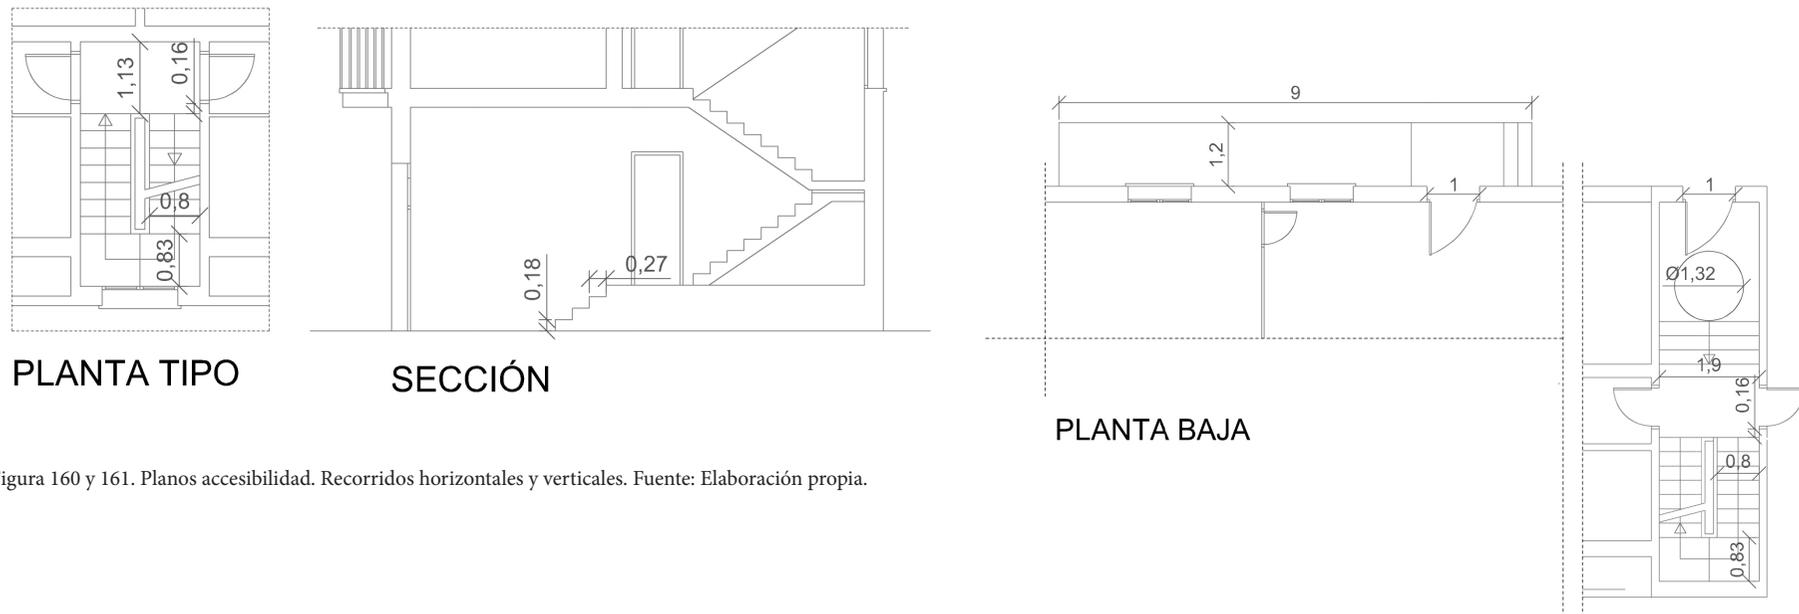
y 161. Planos accesibilidad. Recorridos horizontales y verticales. Fuente: Elaboración propia.
